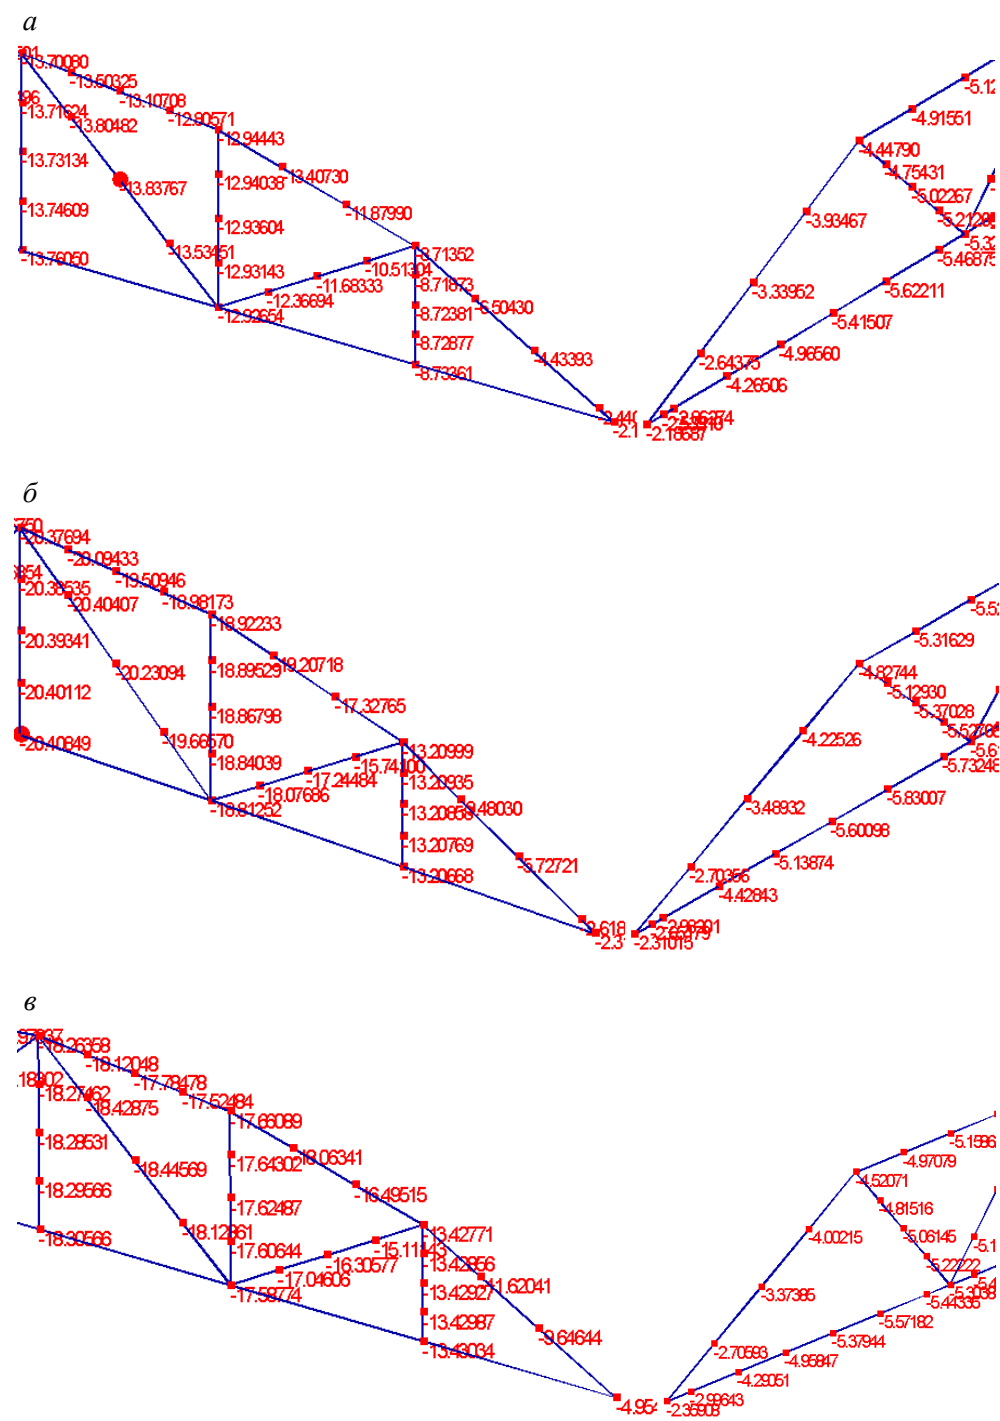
Значения вертикальных перемещений рядовых стропильной и подстропильной ферм:
